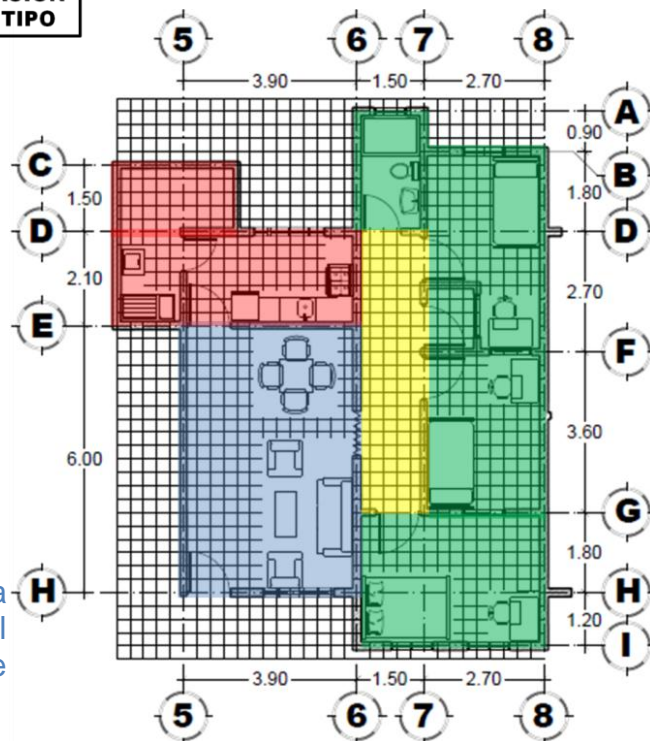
Zonificación, Planta Arquitectónica Tipo, Primer Nivel. (Modelo Estándar) Fuente: Grupo de Trabajo.
